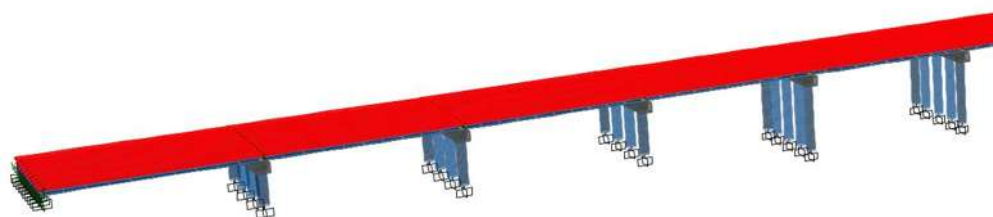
Elementos tipo placa (color rojo) y elementos tipo barra (color azul) utilizados para modelar los elementos del puente Miguel Alemán.
